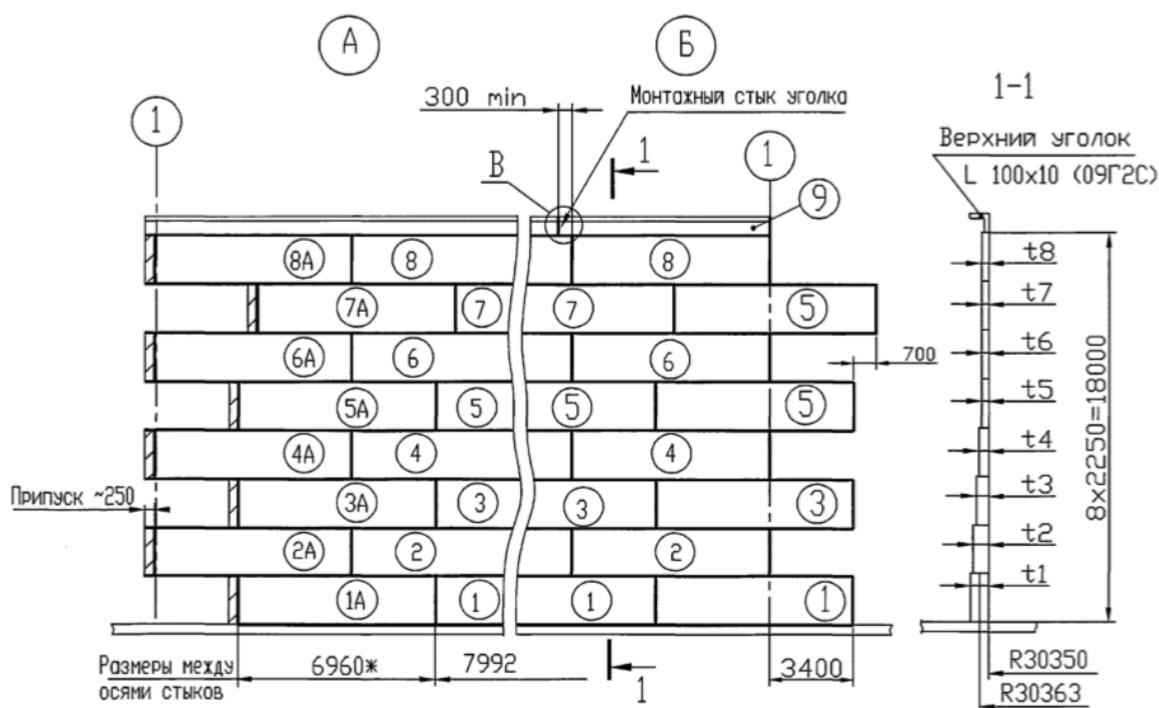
Схема стенки резервуара типа РВСПК-50000 м³.
